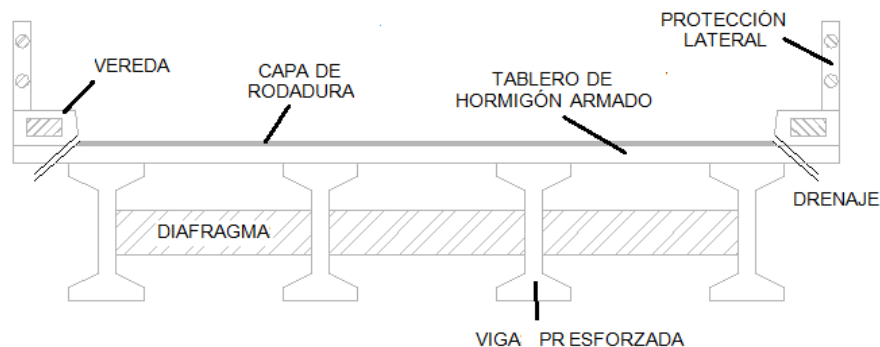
Sección transversal compuesta de un puente de hormigón armado con vigas de hormigón presforzadas. Tipo I [29]
